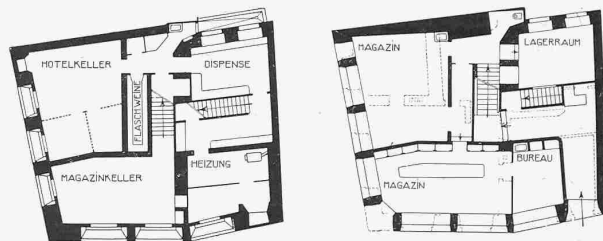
Grundrisse zum Hotel Post in Luzern. — Masstab 1 : 400.
